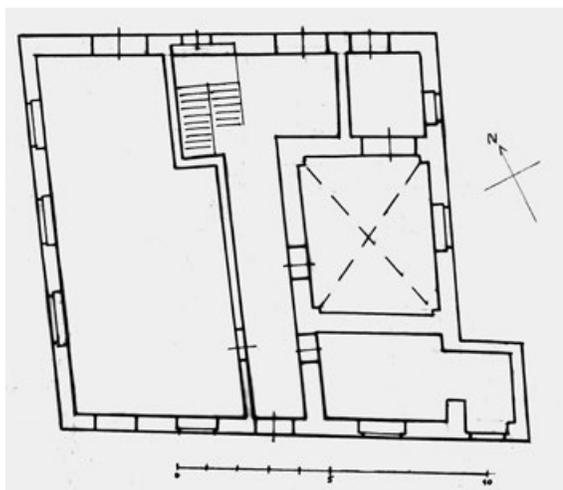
Biberach, Engelgasse 4, Erdgeschossgrundriss mit Eintragung des Deckenbalkens von circa 1370 (nach Bestandsplan von 1960).
